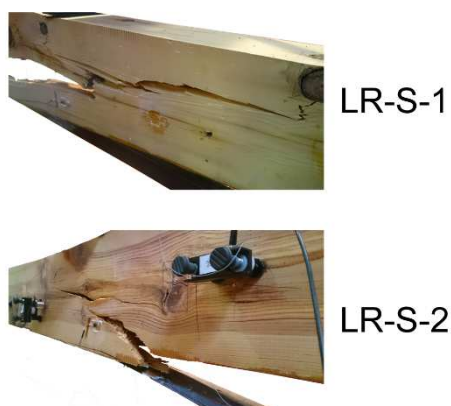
Imágenes de las roturas de las vigas con refuerzo longitudinal de gran escuadría (LR). Arriba: LR-S-1. Abajo: LR-S-2. Casa comercial: SIKA®.
